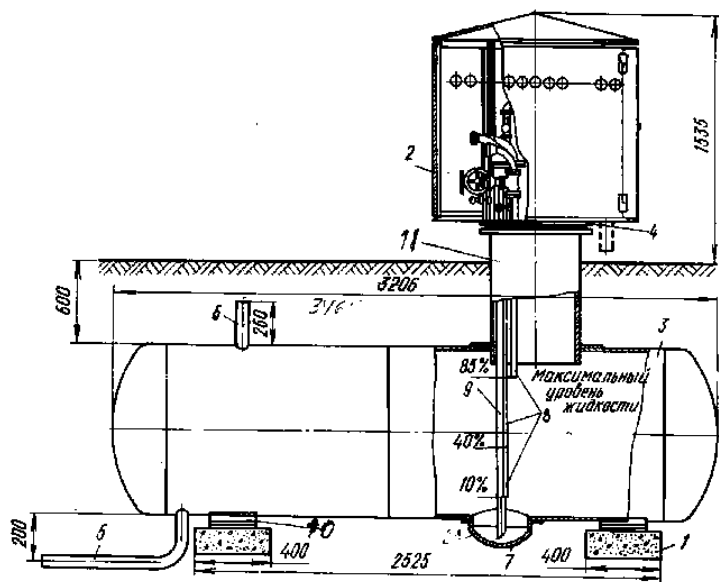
Подземный резервуар групповой резервуарной установки:
